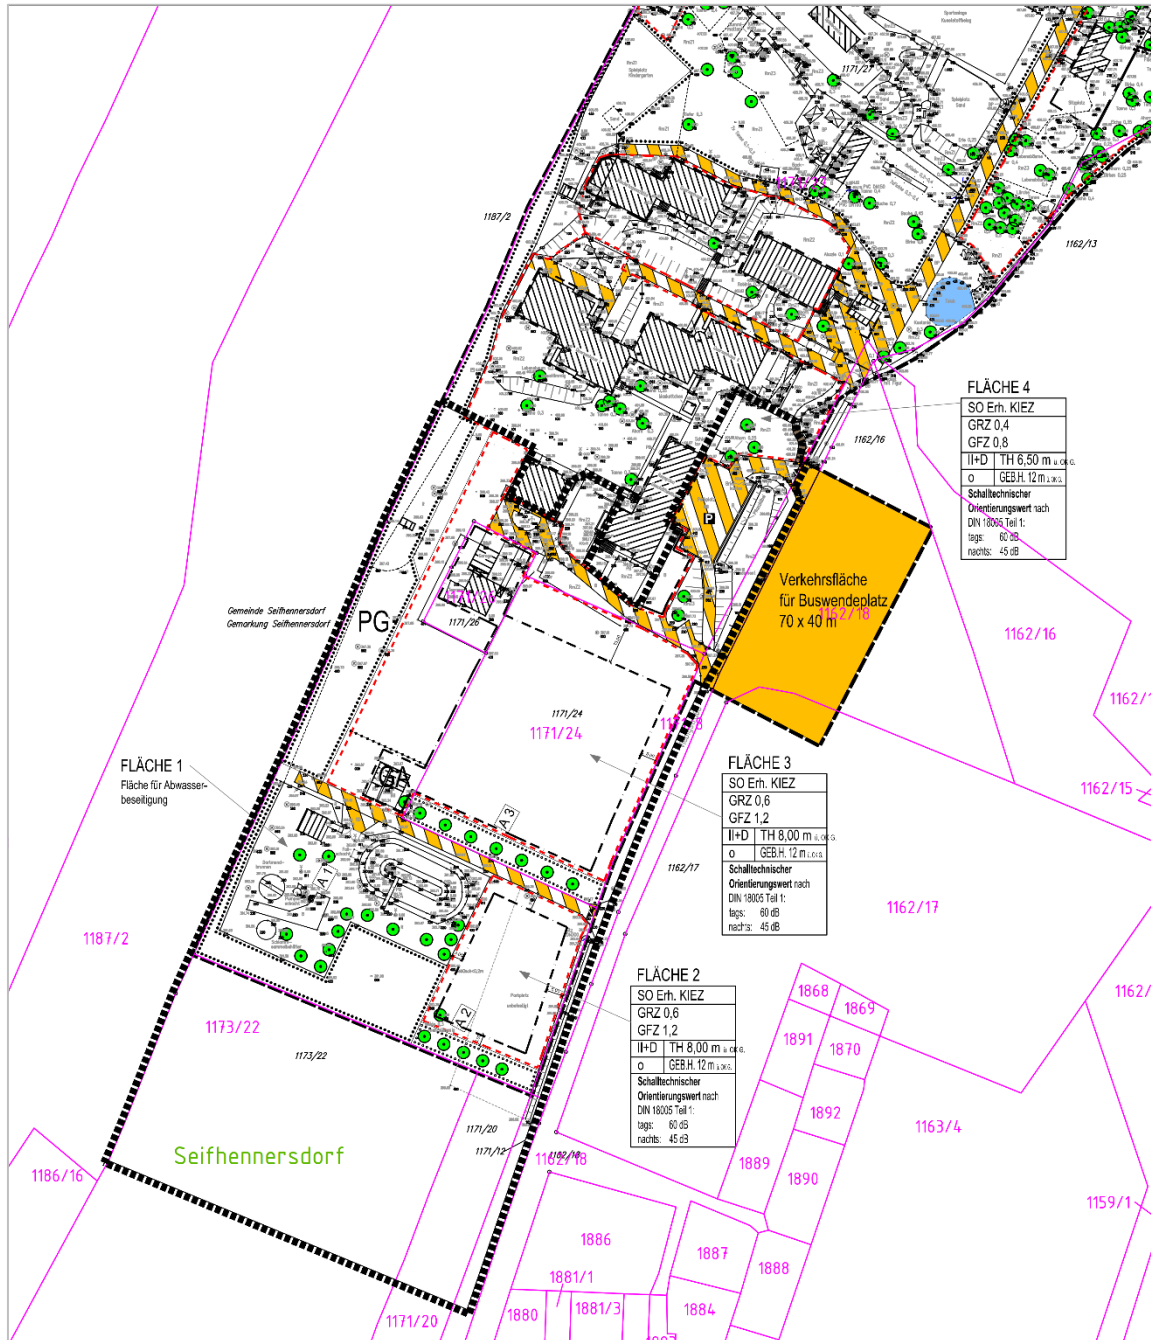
Auszug aus rechtskräftigen B-Plan mit Darstellung des Geltungsbereiches der 1. Änderung
